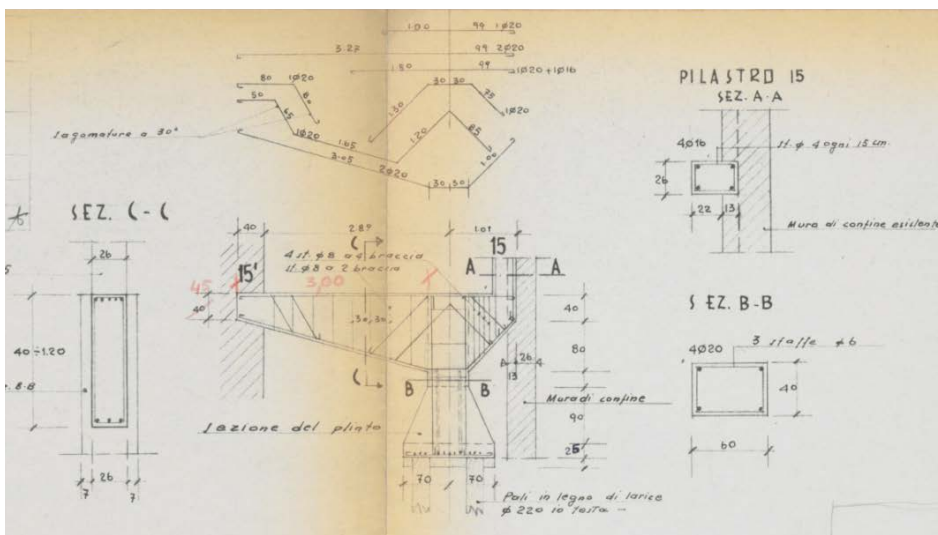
Estratto tavola fondazioni, dettaglio plinto (1960) - (Archivio del Comune di Padova)
